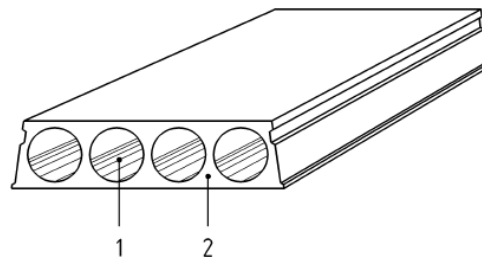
EXEMPLO DE LAJE ALVEOLAR.
